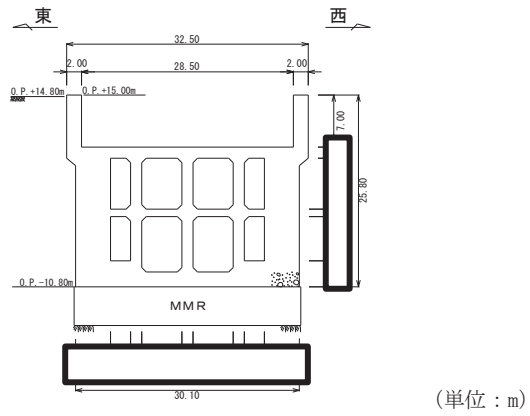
海水ポンプ室断面図 (A-A 断面, 東西)
